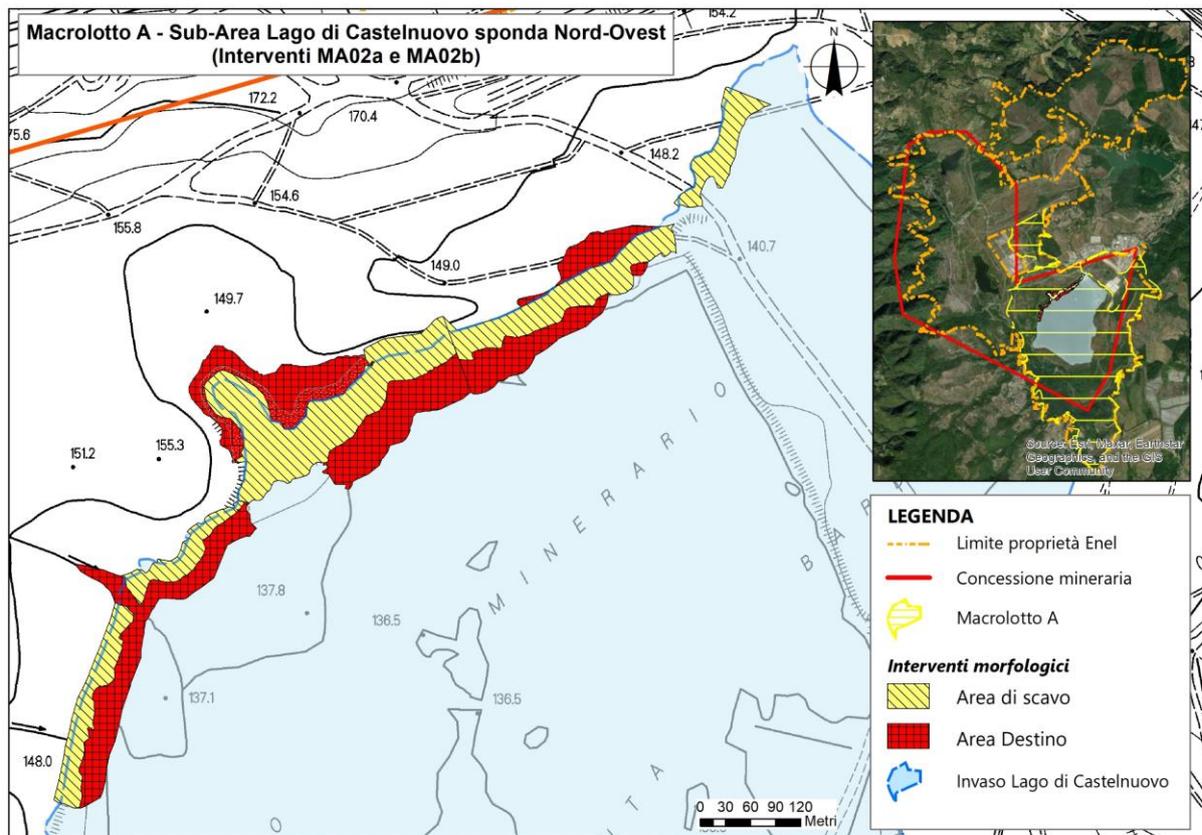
MA02 - Lago Castelnuovo sponda Nord-Ovest: ubicazione dell'area d'intervento.
